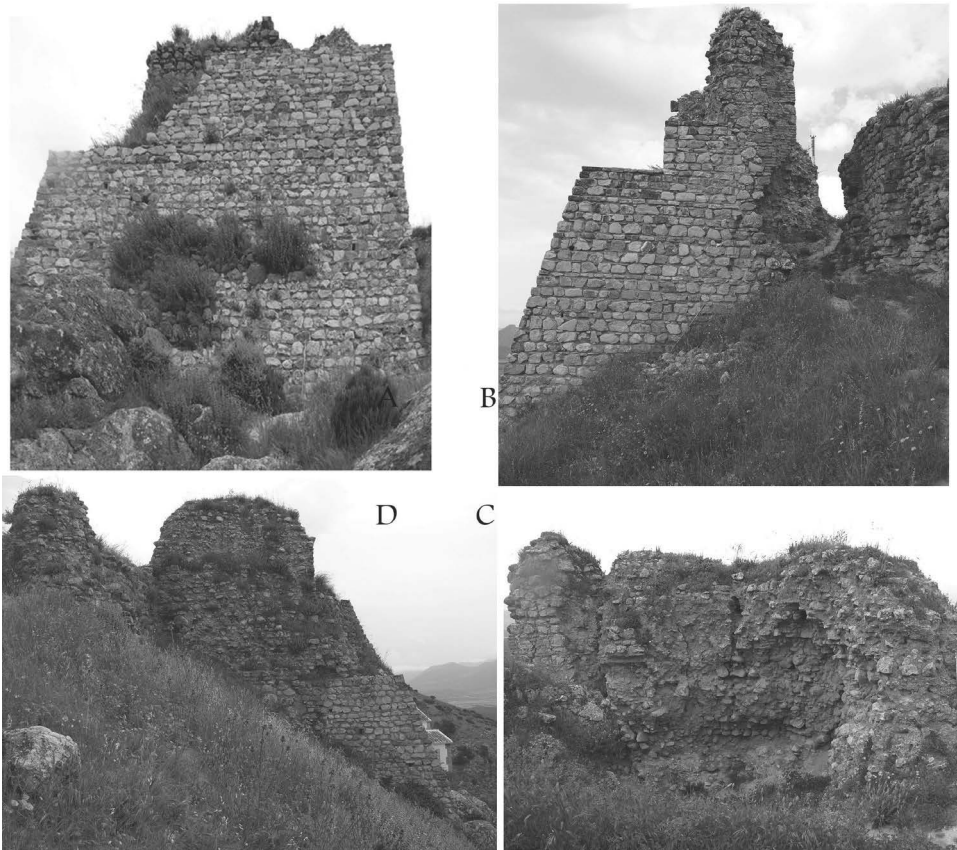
Algunos detalles constructivos del castillo. La puerta de la fortaleza. El primer cinturón de las murallas. (A): Torre T3 en su cara exterior suroeste. (B): la cara exterior sureste. La técnica constructiva es tapial de calicanto y mampostería enripiada con sillarejo. se observa que el tapial de calicanto ha sido rehecho de ladrillo en la cara sureste y en otras el tapial de calicanto se ha reconstruido con obra de mampostería verdugada de piedras. (C): la cara interior noreste. (D): la cara exterior noroeste. La fabricación es de mampostería, cimentada sobre la roca del cerro, que ha sido restaurada recientemente. Aparecen huellas de tapial, probable fabricación original de la torre. Está claro que en las caras noreste y noroeste el muro está revestido con mampostería concertada con piedras regulares en hiladas con mortero de cal.
